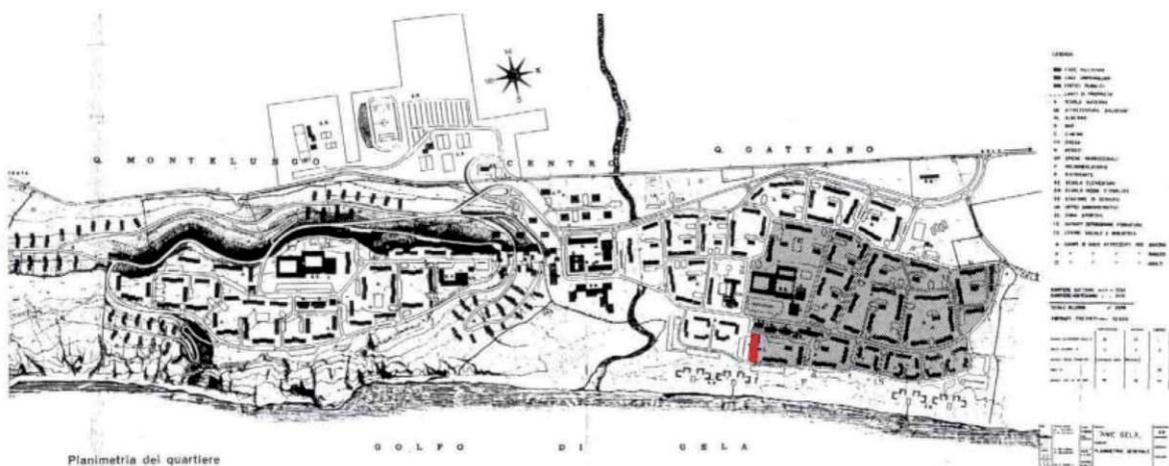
planimetria del progetto Nizzoli con individuazione in rosso della clinica Santa Barbara
